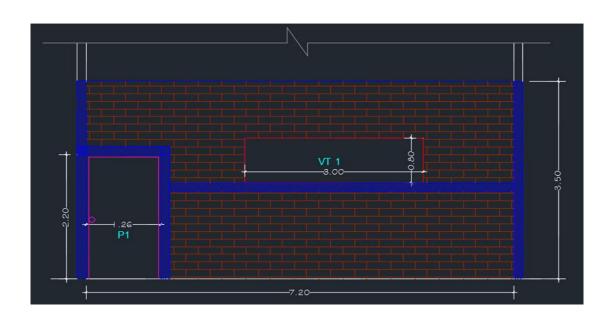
detalle de cálculo de mampostería de bloques de hormigón Fuente: Kevin Ronald Armas Padilla
